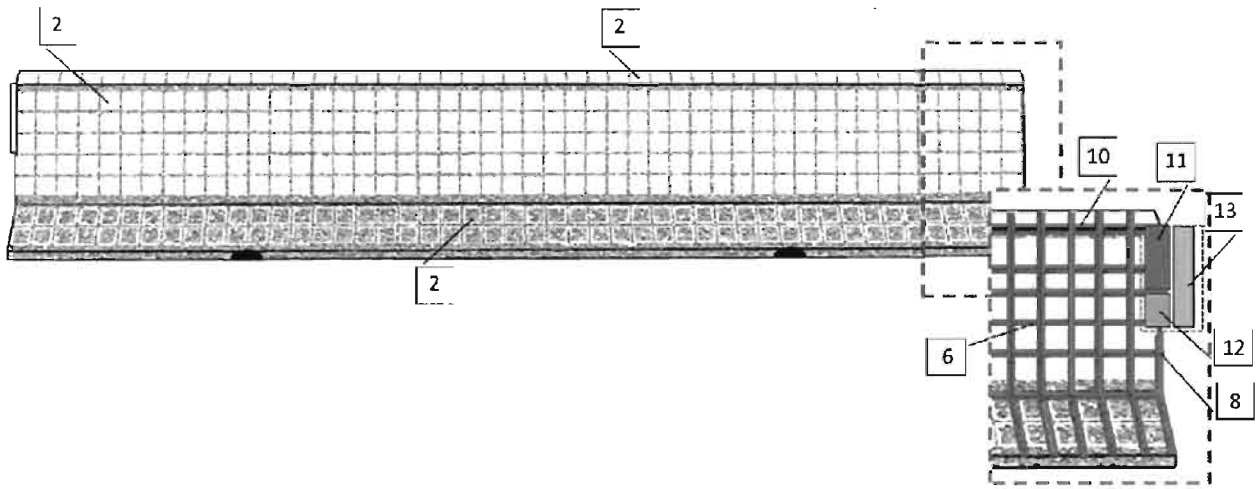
Secțiune longitudinală B-B - Parapete prefabricate pentru drumuri, poduri și autostrăzi care înglobează celule fotovoltaice
